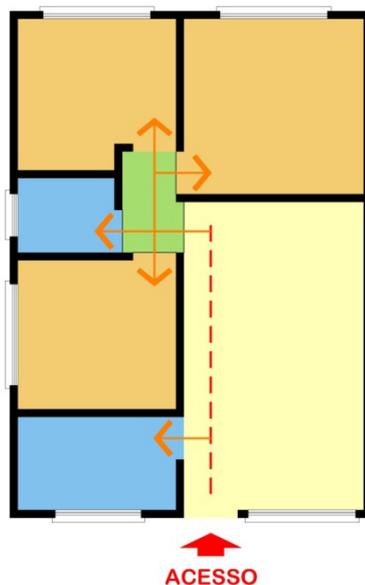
Planta esquemática com a setorização funcional e fluxos de circulação
